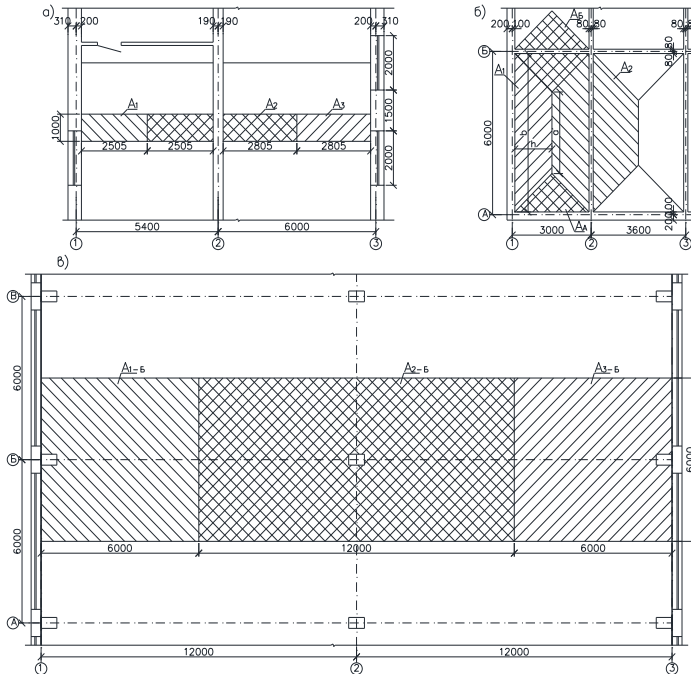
Схема визначення вантажних площ: а) опирання плит перекриття на поздовжні (поперечні) несучі стіни; б) опирання плит перекриття по контуру; в) каркасно конструктивна схема будівлі.
